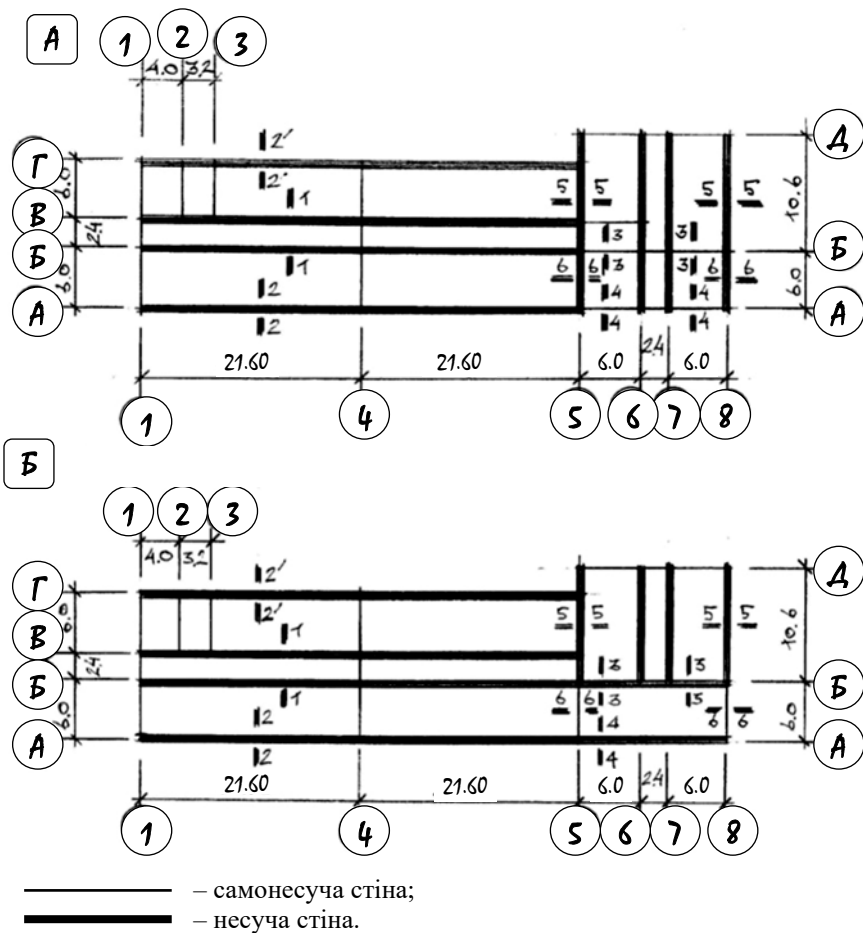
Розрахункові січення для збору навантажень на фундаменти досліджуваної будівлі:
